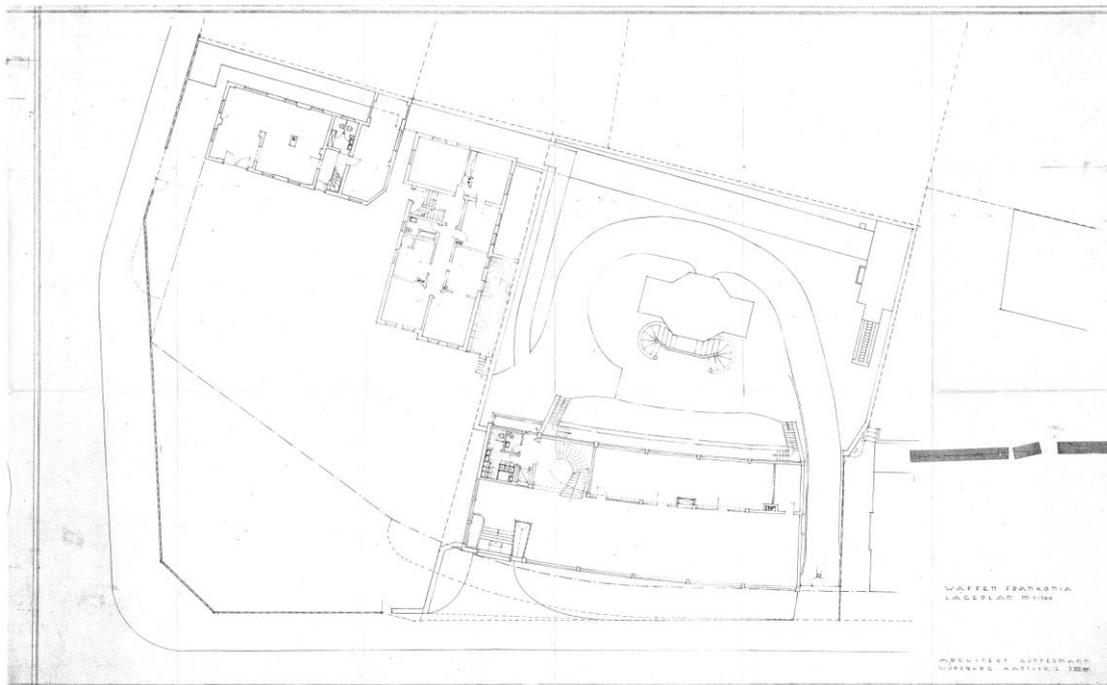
Übersichtsplan, Lageplan, Architekturbüro Karl Gundermann, 1959.
